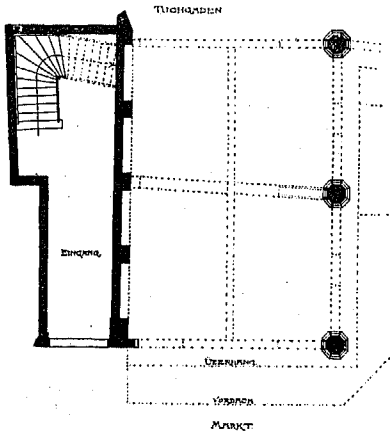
Neues Rothes Haus auf dem Markt; Grundriss.
